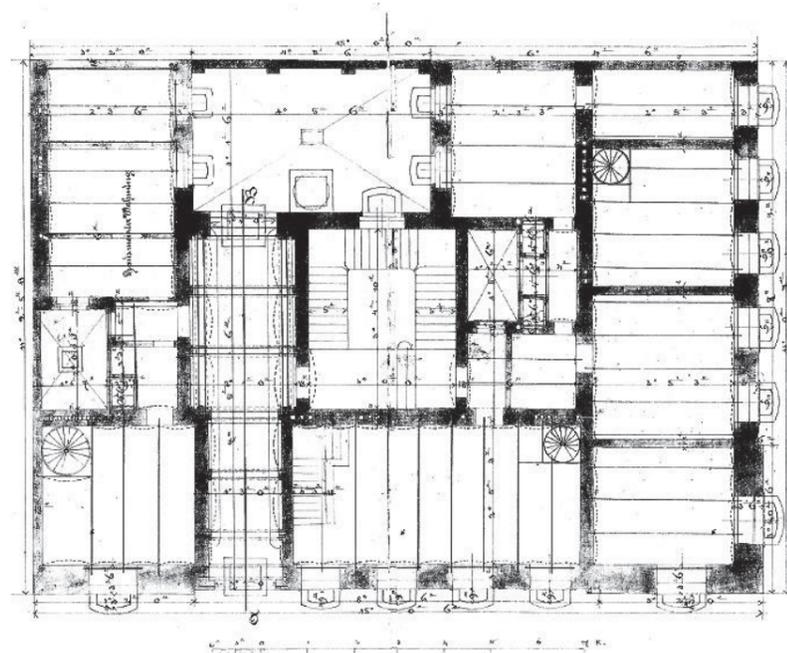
Grundriss Erdgeschoss, Block B
